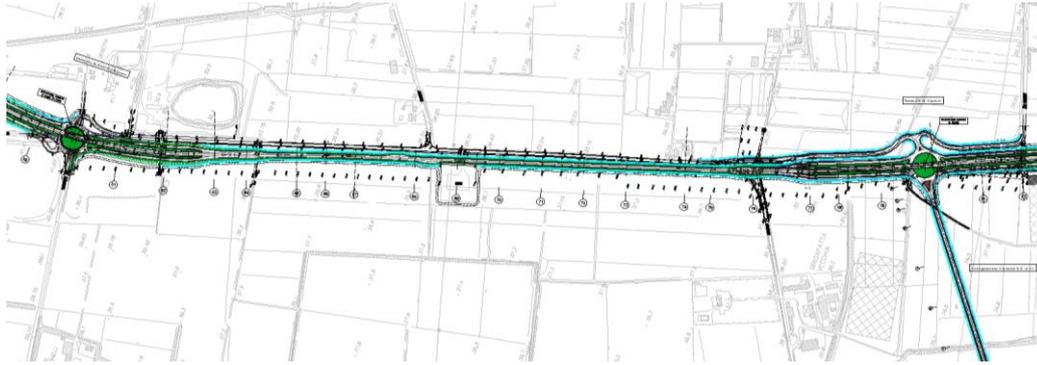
Tratto Svincolo di Castel d'Azzano - Svincolo di Vigasio - Planimetria
